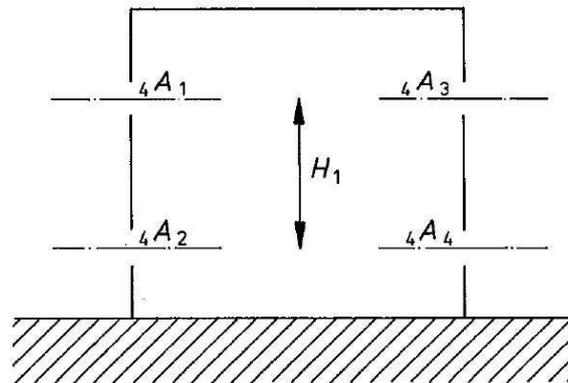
porção do pavimento-tipo do edifício Mauá modificado para o cálculo da ventilação.
